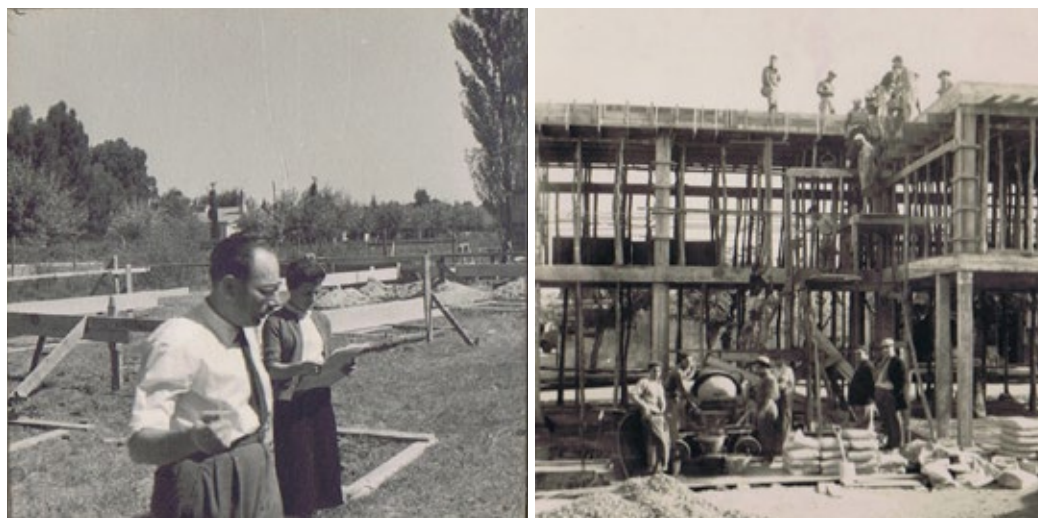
| Los arquitectos Muras y Giraldi en las obras de la Vivienda Spielmann y la Junta de Paso de los Toros. Fuente: donación Muras–Giraldi al CD–IH.
